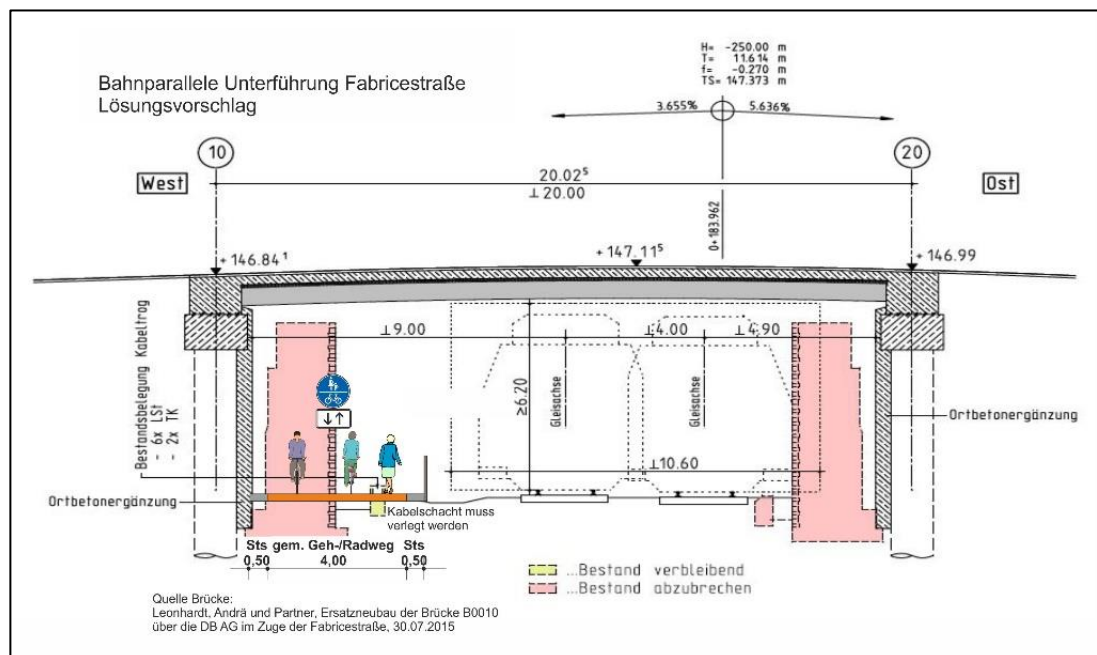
Führung des Rad- und Fußverkehrs durch eine erweiterte Brückendurchlass im Zusammenhang mit dem Neubau der Bahnüberführung Fabricestraße
